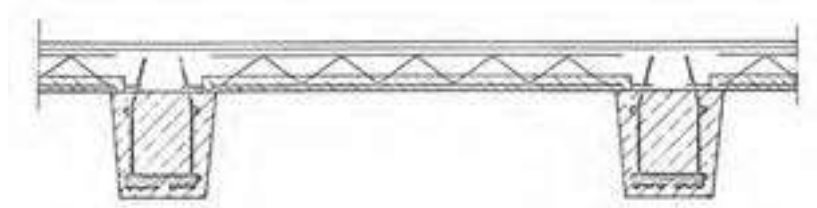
Zeichnung einer Balkenelementdecke (aus [21])
